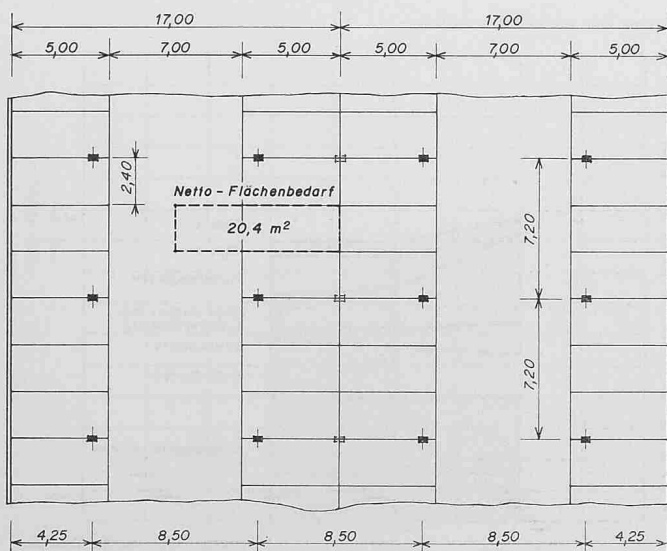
Typischer Grundriss (Ausschnitt) einer unterirdischen Autoabstellanlage
